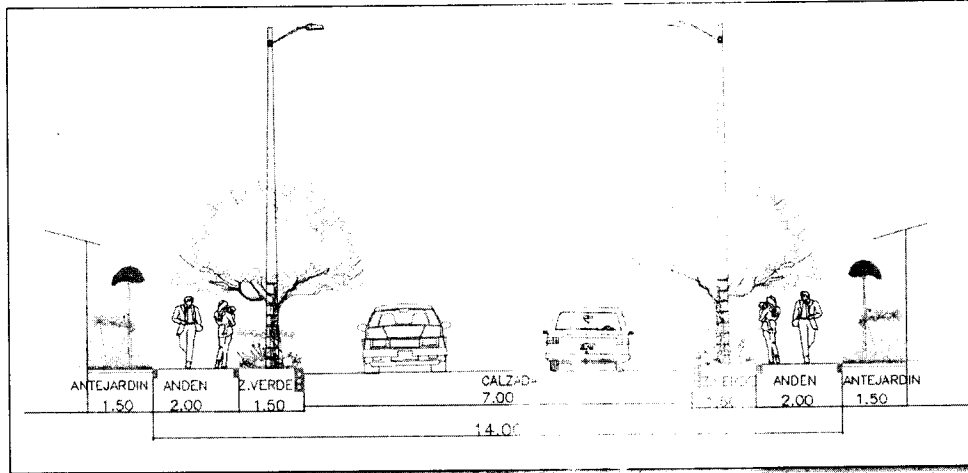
Distribución en planta Perfil Vía VLR (14 MTS)
